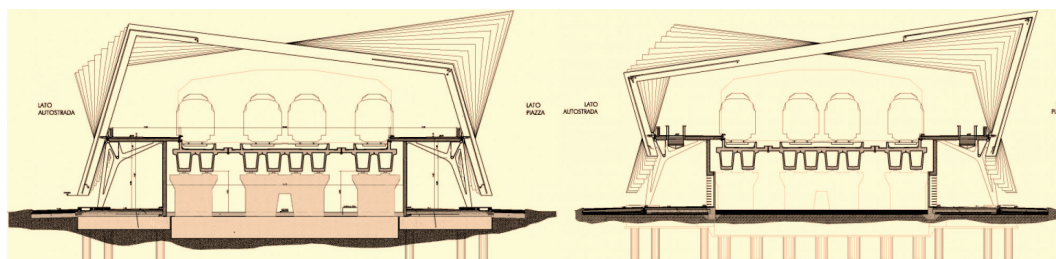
Sezione trasversale della stazione con le onde sul lato piazza in fase crescente.
